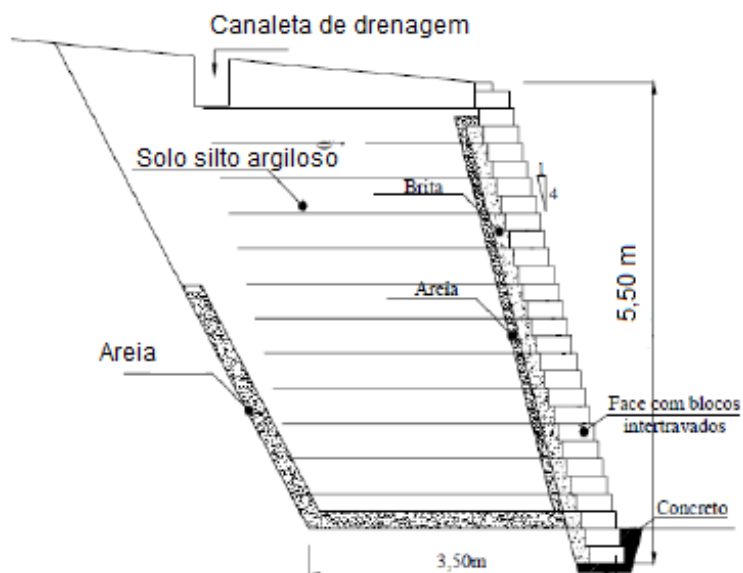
Corte esquemático do muro. Fonte: Rodrigues et al. (2016).
